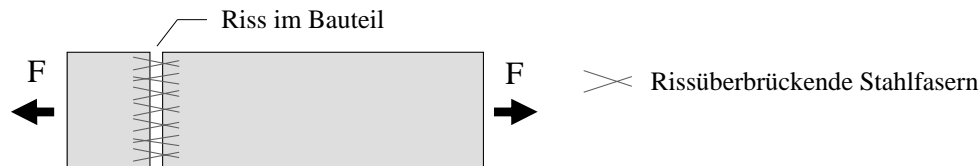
Schematische Darstellung der rissüberbrückenden Stahlfasern im Betonbauteil
